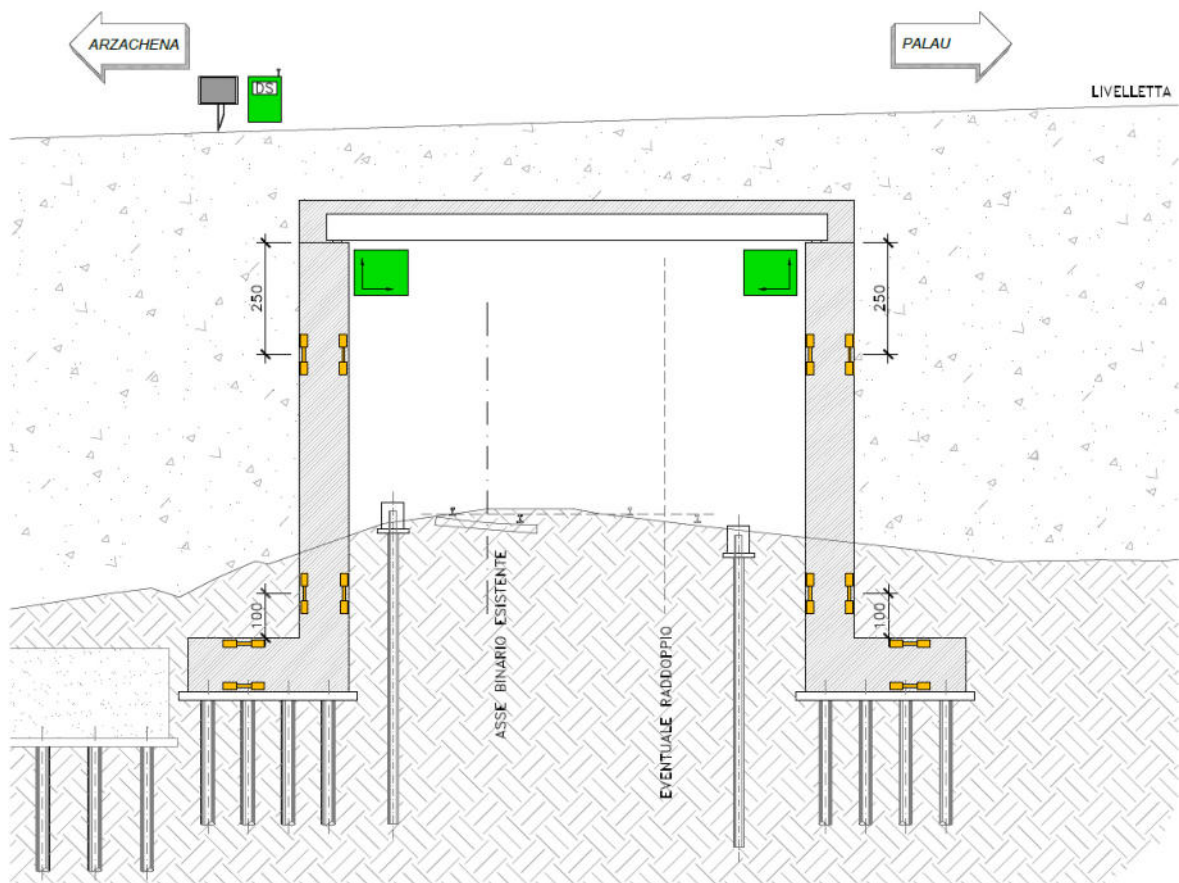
Schema posizionamento strumentazioni cavalcavia e cavalferrovia – Sezione MG01
